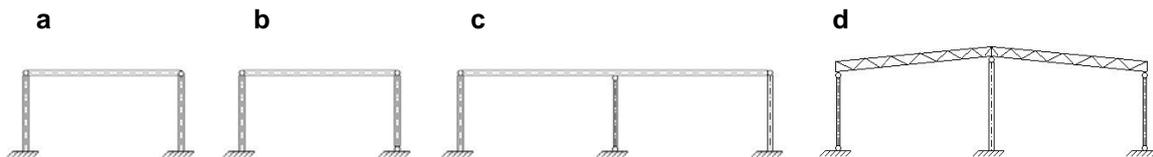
Rahmengrundformen mit eingespannten Stützen
